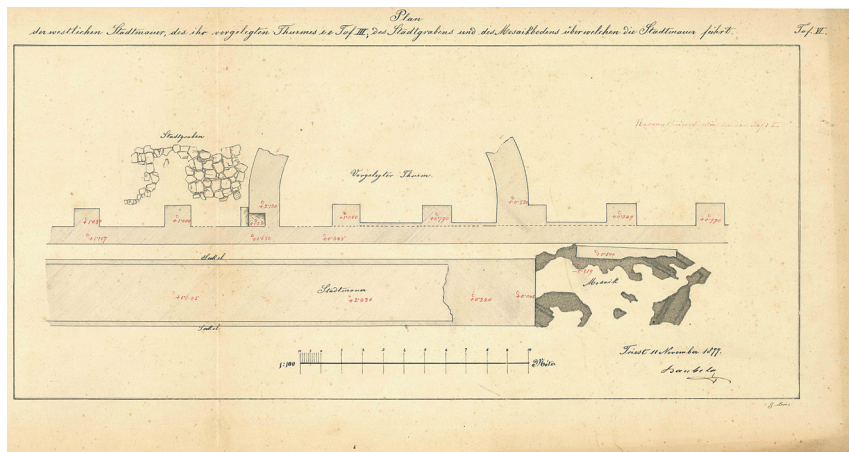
Plan der westlichen Stadtmauern, Taf. VI (MAN Aquileia, disegni, inv. n. 1808).
